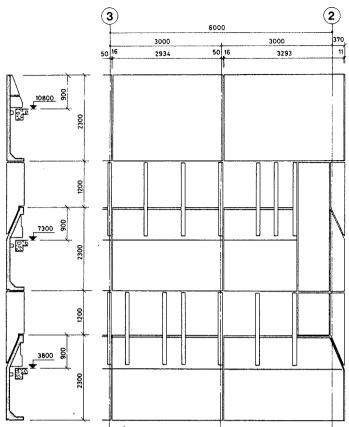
Facadeopstalt og oversigtssnit, 1:100. Bemærk at facadeelementerne er rykket 50 mm ud af deres modulområde; dette er gjort aht. finneelementets fastgørelse til facaden, idet der ønskedes en centreret modulplacering af finnen. Lodrette og vandrette hovedmål for elementerne er oplyst.
